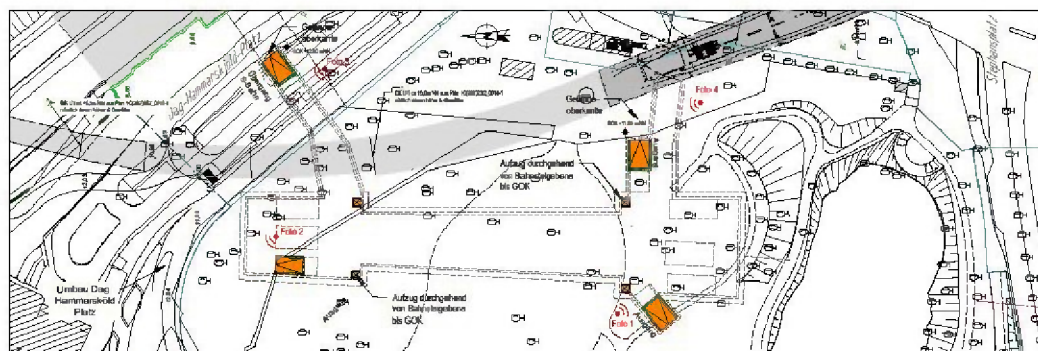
Lageplan Haltestelle Jungfernstieg
